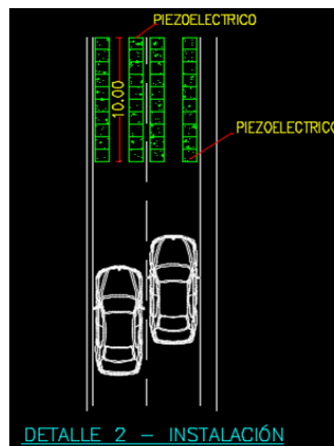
Detalle de instalación Avenida Boyacá por calzada (Del autor)
